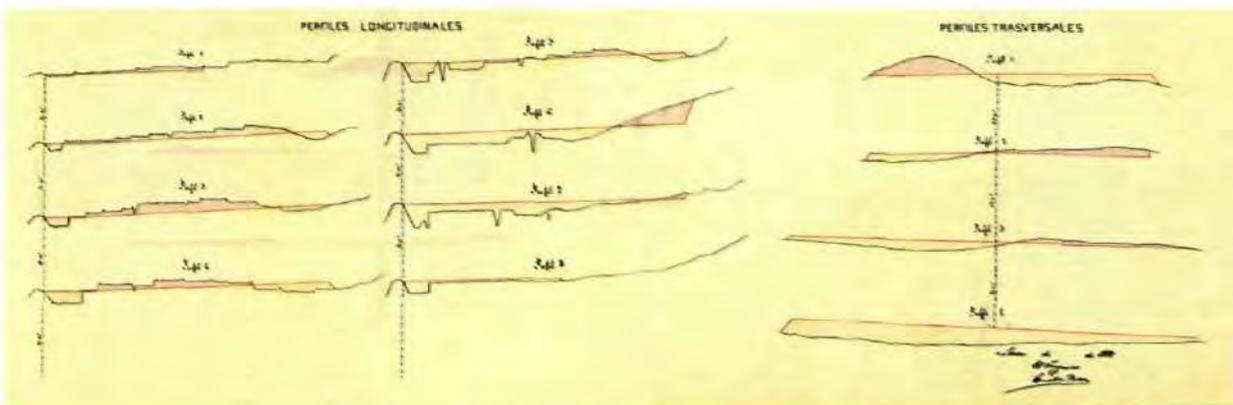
Perfiles del cementerio. Ingeniero Riera. 1888
